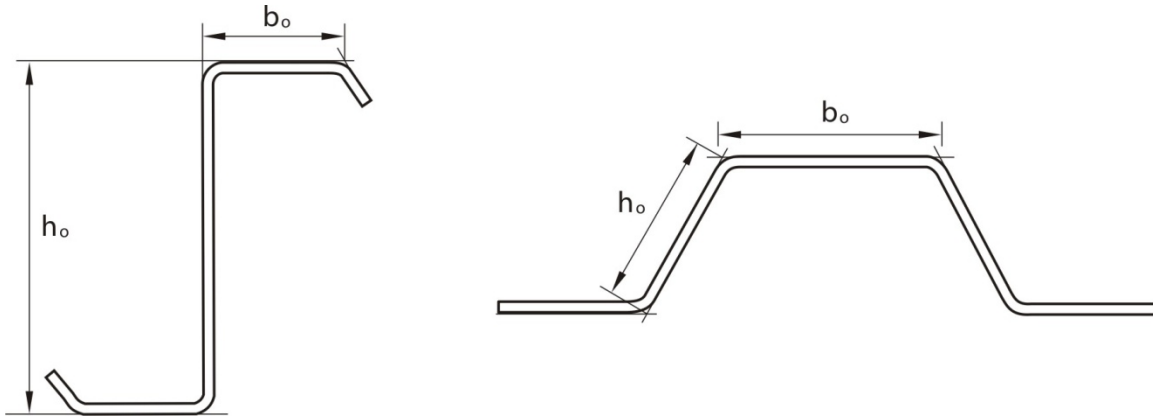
Dimensiones entre bordes externos de almas y elementos rigidizados bajo gradiente de esfuerzo
